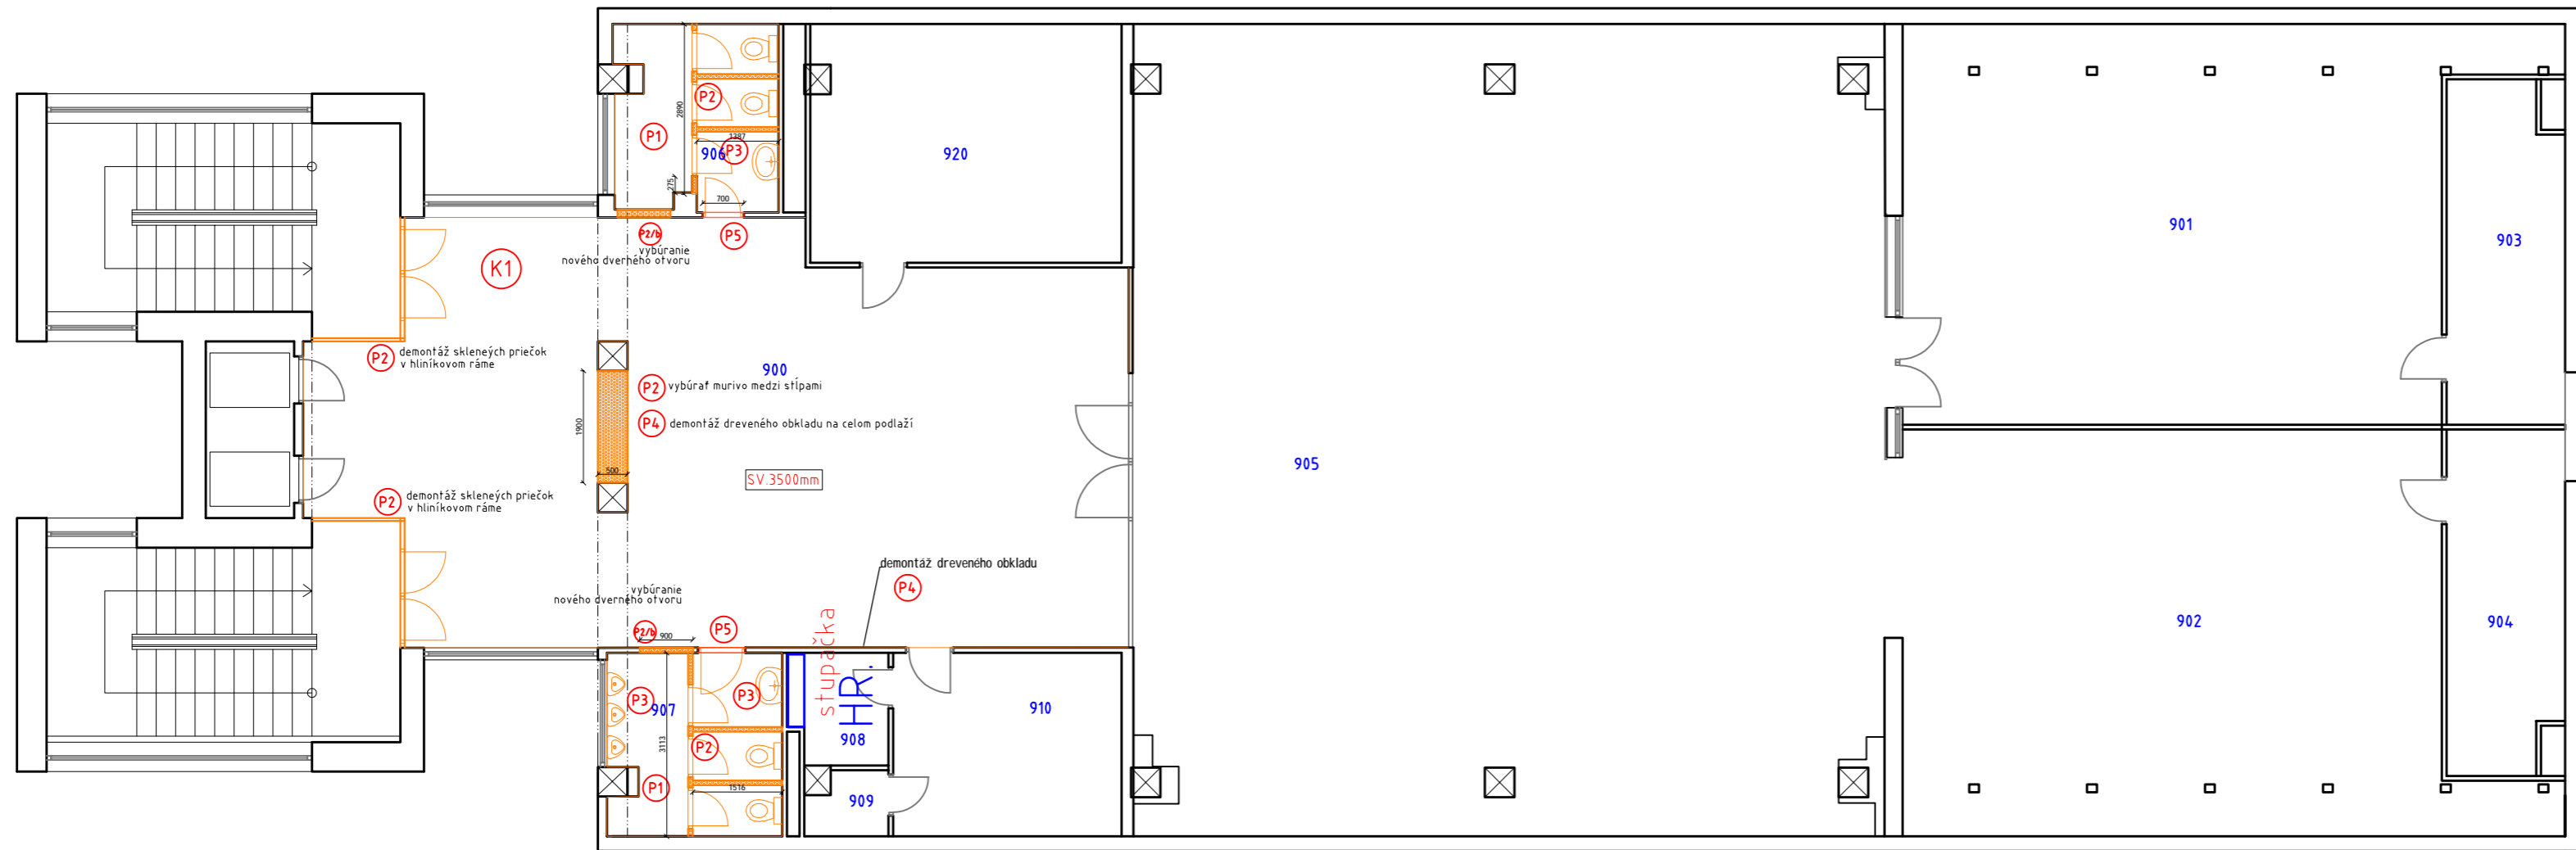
DETAIL WC (+vychov.) 8.NP\_internát m 1:150
